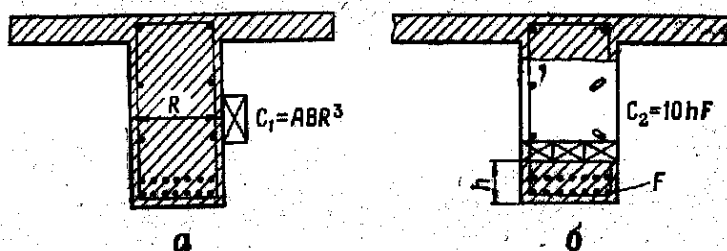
Раздельное (последовательное) взрывание бетона и арматуры:
